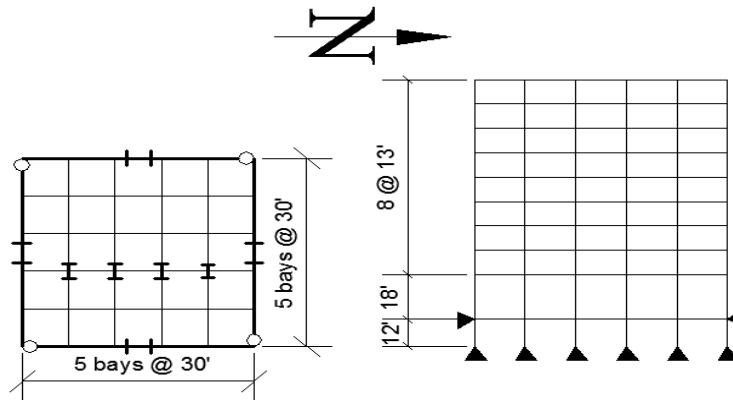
Planta y elevación del Modelo de 9 niveles.
